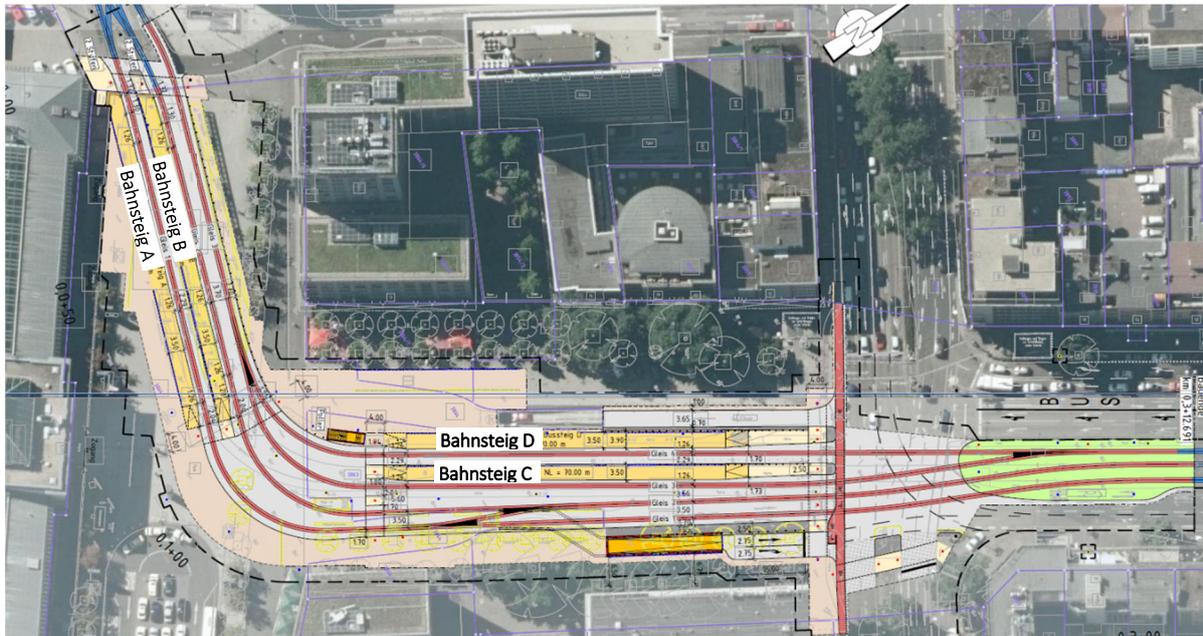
Variante 2 (detaillierte Plandarstellung siehe Anlage 6)
